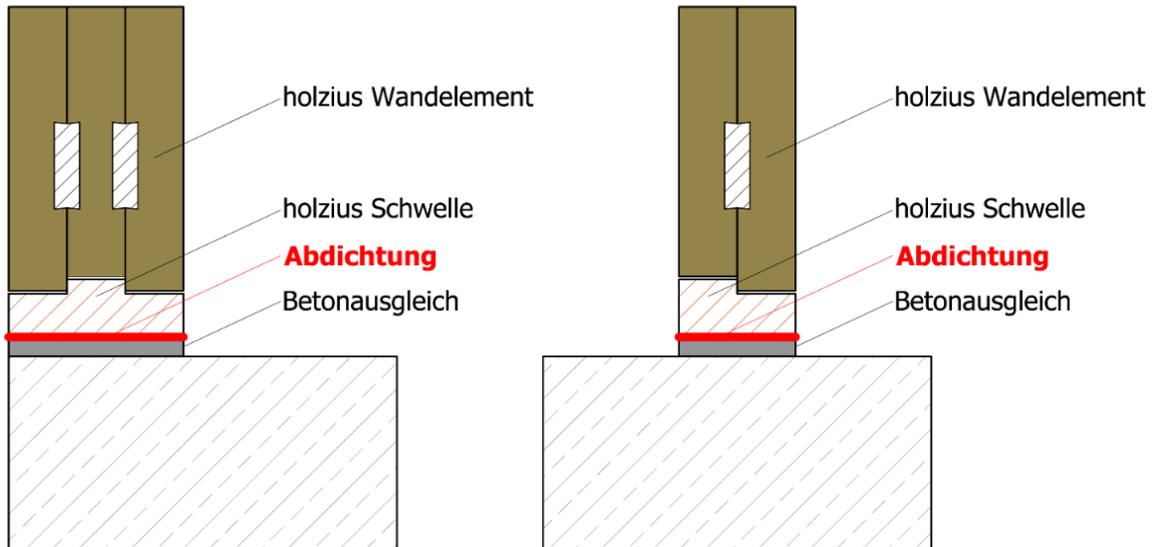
Dettagli collegamento del pavimento parete esterna e interna
